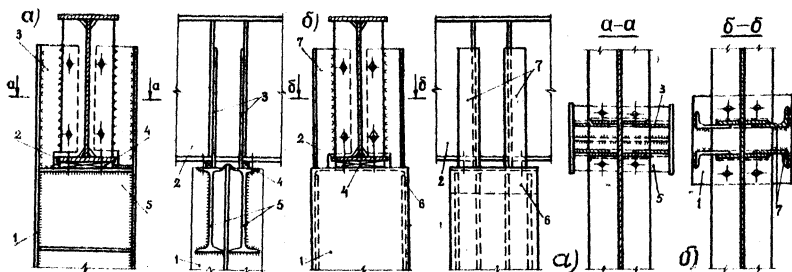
Конструкция сопряжения подстропильных балок со стальными (а) и железобетонными (б) колоннами:
